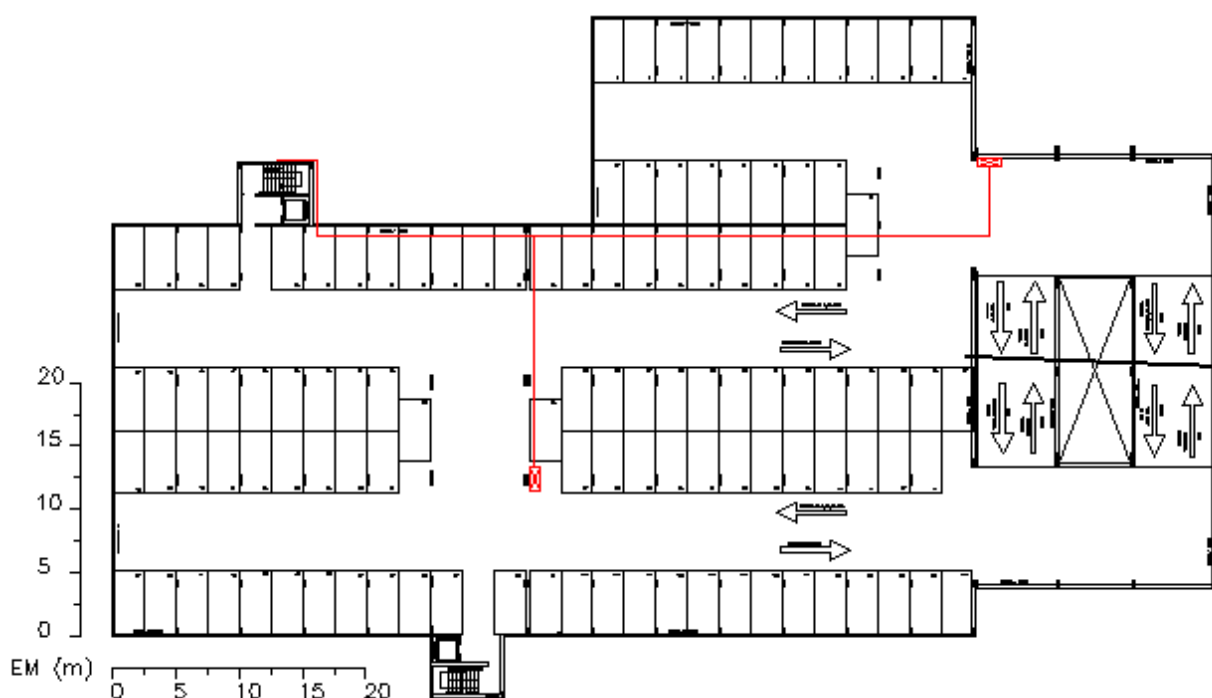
Rede de Hidrantes no Pavimento Tipo (2° ao 6°)
